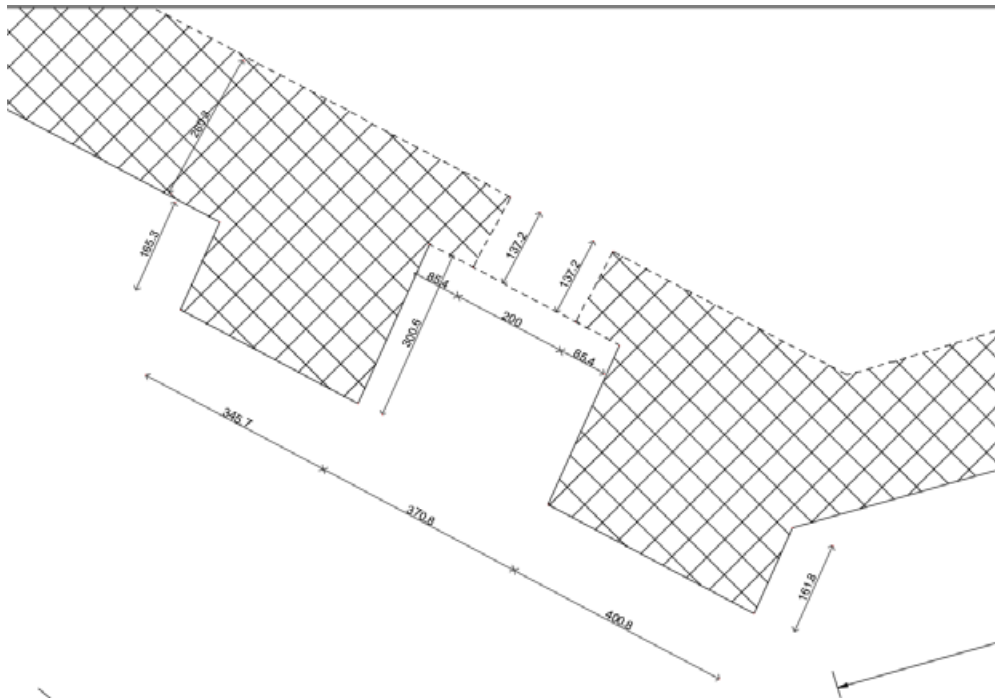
Planimetria della seconda porta del sito di Dorëz
